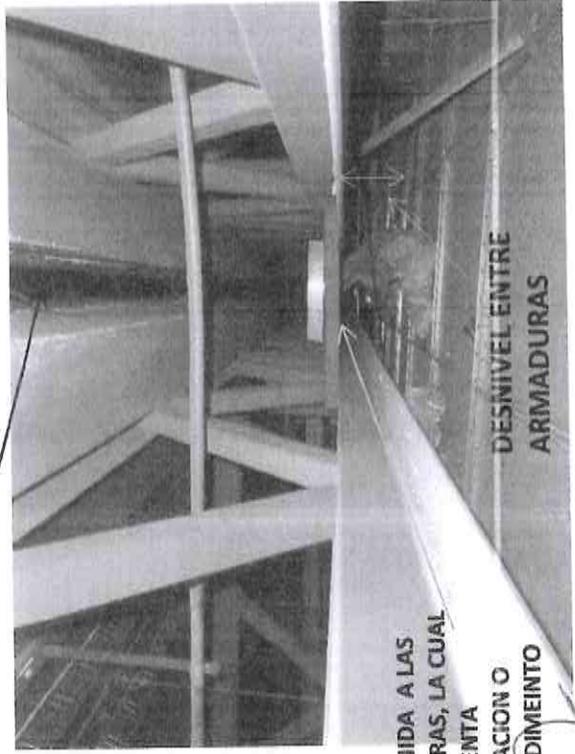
y 42.- En la junta constructiva sobre el eje arquitectónico transversal 13, se observa un probable giro de las columnas y armadura del cuerpo central respecto al cuerpo oriente del edificio, toda vez que se advierte una separación de 2 cm entre el cajillo de tablaroca y la columna B-13, sin embargo en la junta constructiva ubicada en el eje 7 entre los cuerpos central y poniente, así como en las armaduras y columnas de los pisos inferiores, no se advierten daño o desplazamiento de piezas de acero de dichos elementos estructurales. Tampoco se observa en el entorno del edificio a nivel de planta baja algún asentamiento que pudiera haber inducido el giro.
